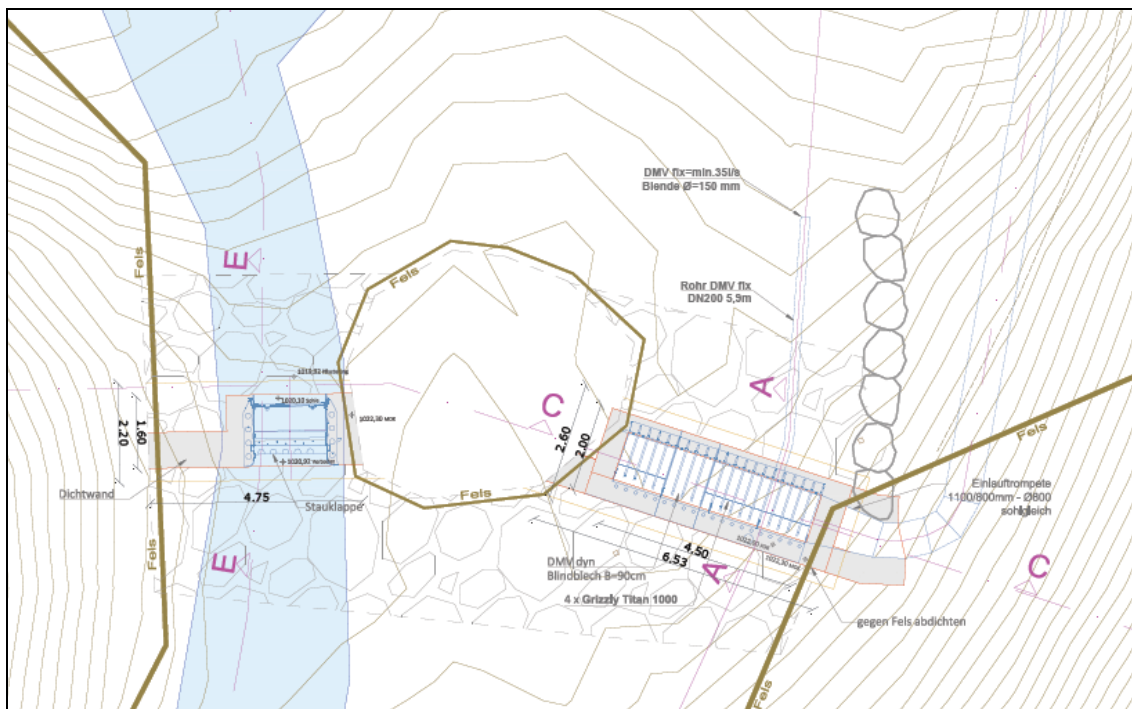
Planimetria opera di presa (fonte: Tavole progettuali)
